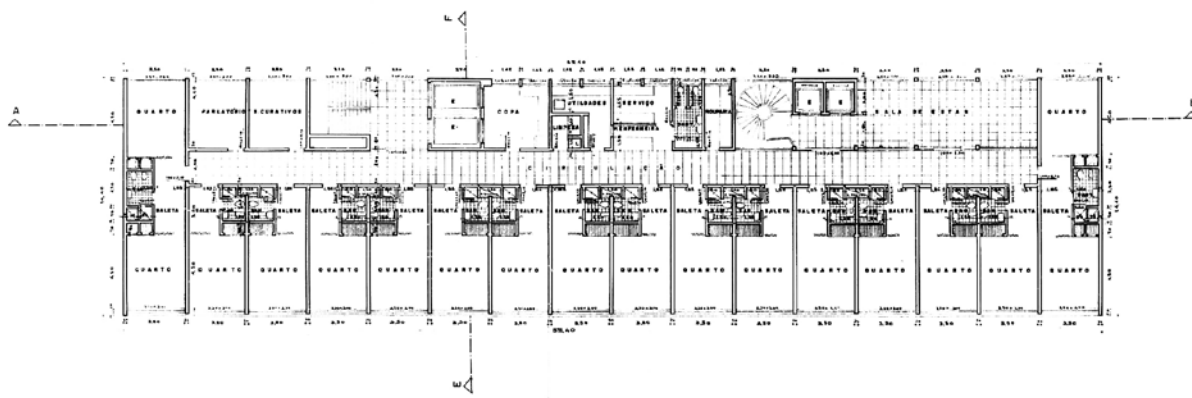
Planta do 7º, 8º, 9º e 10º pavimentos – Hospital Fêmina
